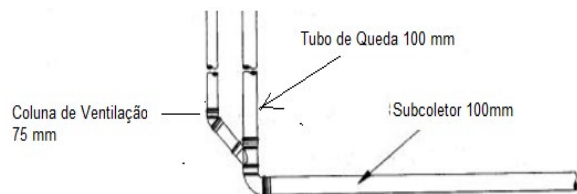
Detalhe da ligação do ramal de ventilação com a coluna de ventilação
